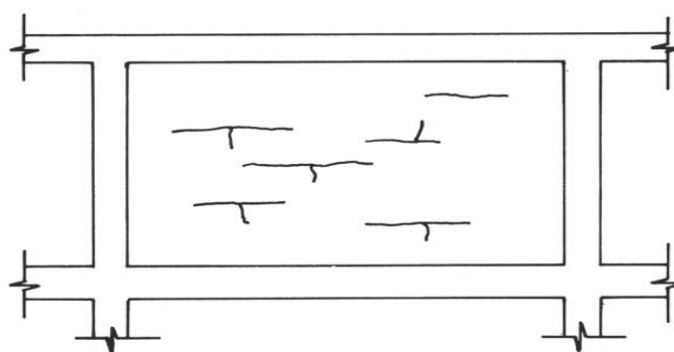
Trinca horizontal provenientes da expansão dos tijolos.
